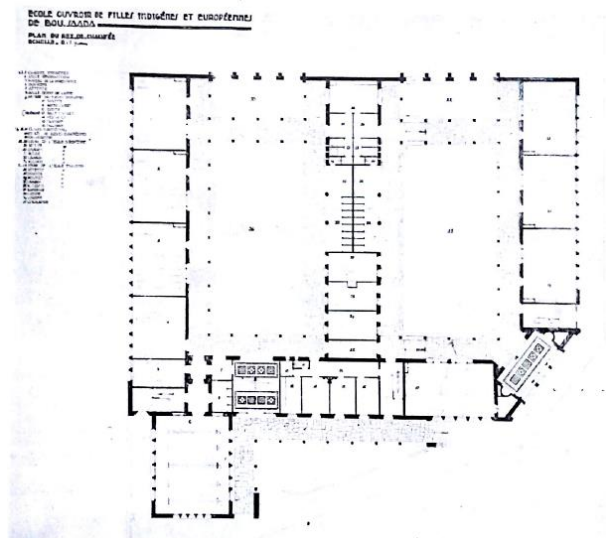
Plan général des Rez-de-chaussée, de l'école-ouvroir.
